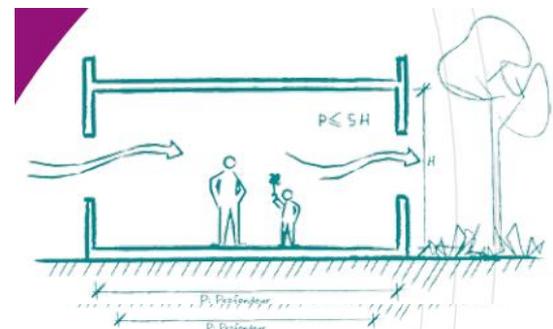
ventilation transversale/source: Natural ventilation in non domestic building.
